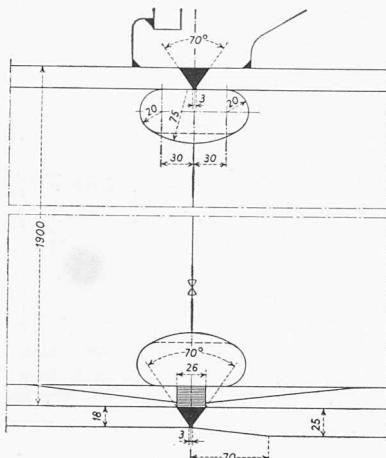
Montageschweissung im Universalstoss, Maßstab 1:7
